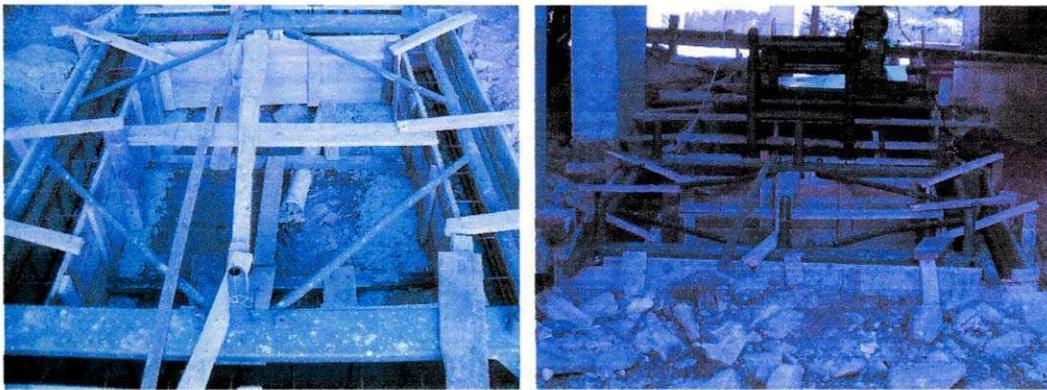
Instalação do elevador de serviço. Figura 75. Instalação do elevador de serviço.
